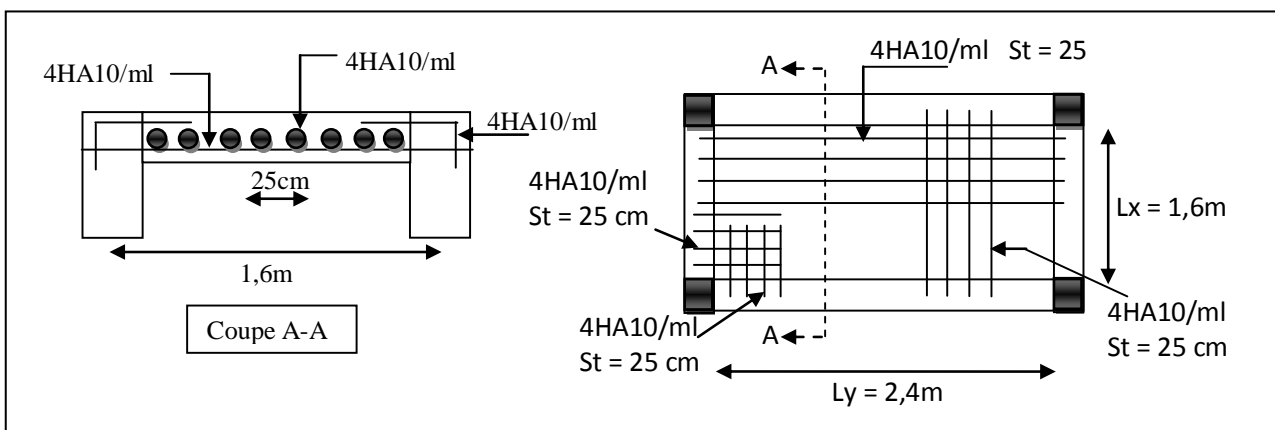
Schéma de ferrailage dalle sur 4 appuis
